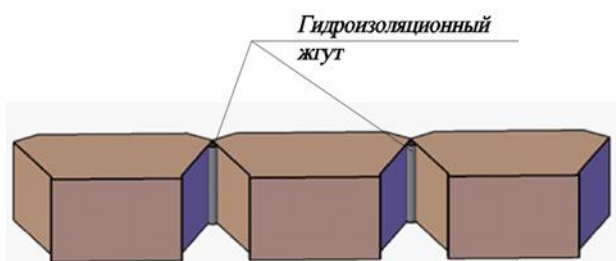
Места укладки гидроизоляционных жгутов с тыльной стороны подпорной стенки
